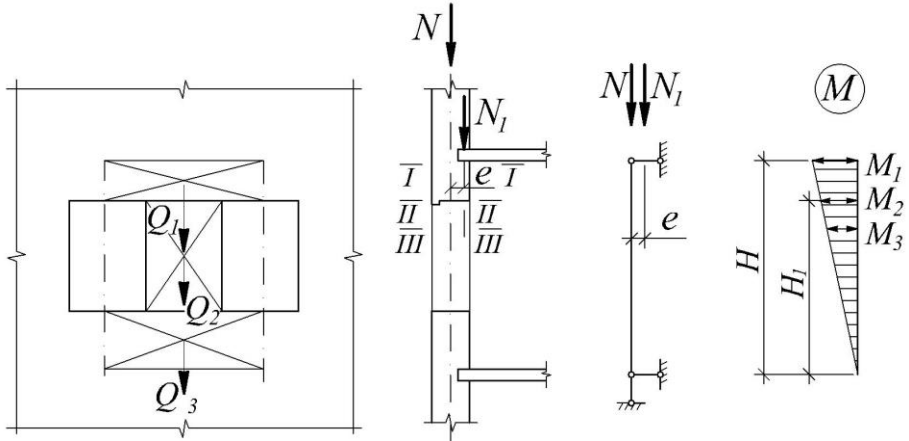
До розрахунку стіни з жорсткою конструктивною схемою на вертикальні навантаження
